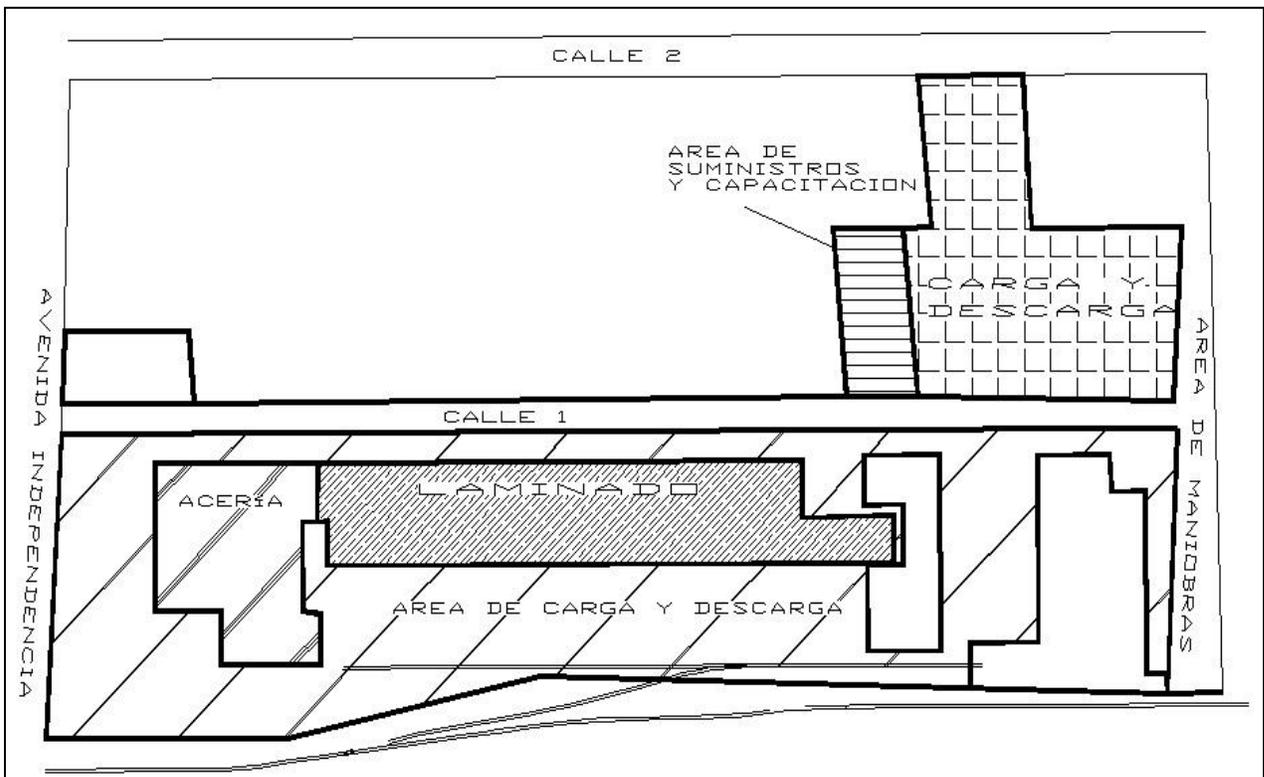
Muestra la distribución de las áreas de la planta siderúrgica
